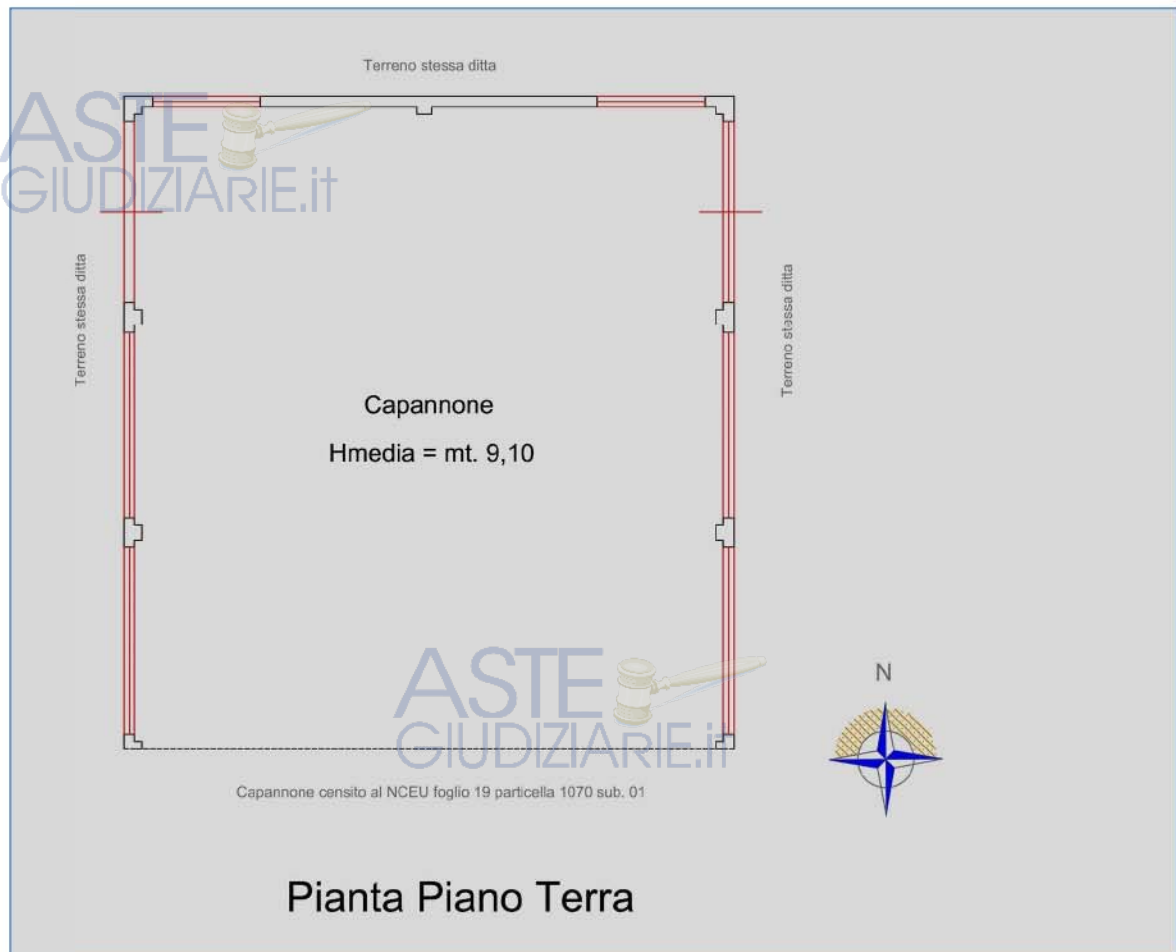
Visualizzazione della planimetria reale dell'immobile così come rilevata dal sottoscritto CTU
